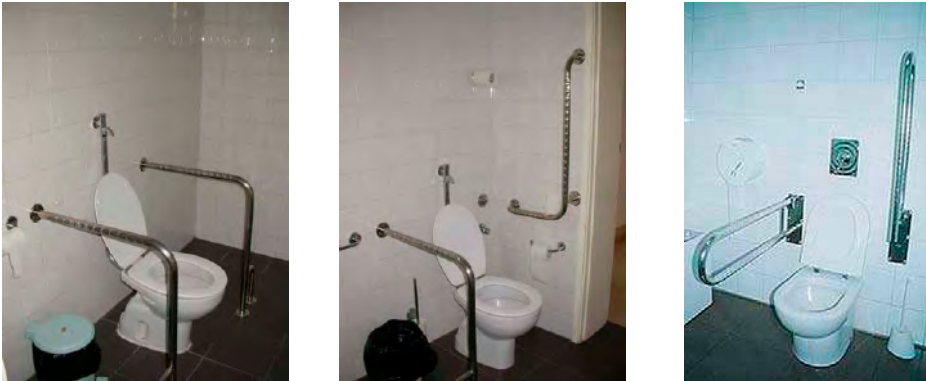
Retretes com barras de apoio fixas no Bloco de Acamados e exemplo de boa colocação de barras de apoio [45]
